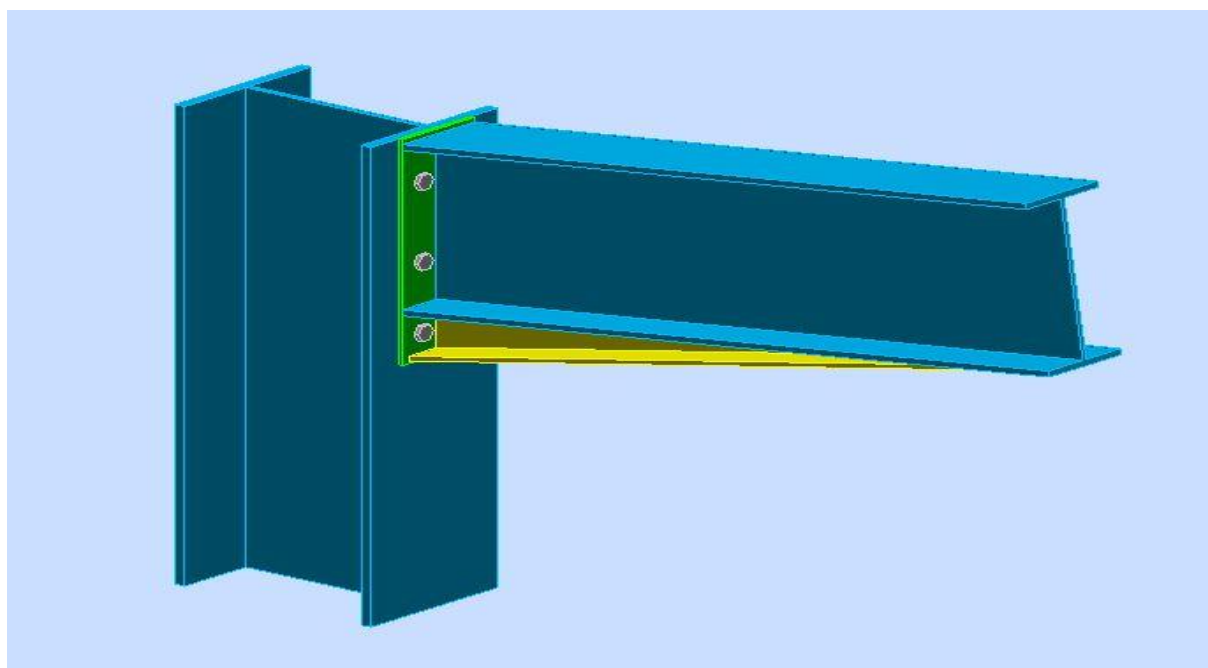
Vue 3D de l'assemblage poteau traverse IPE 360.
